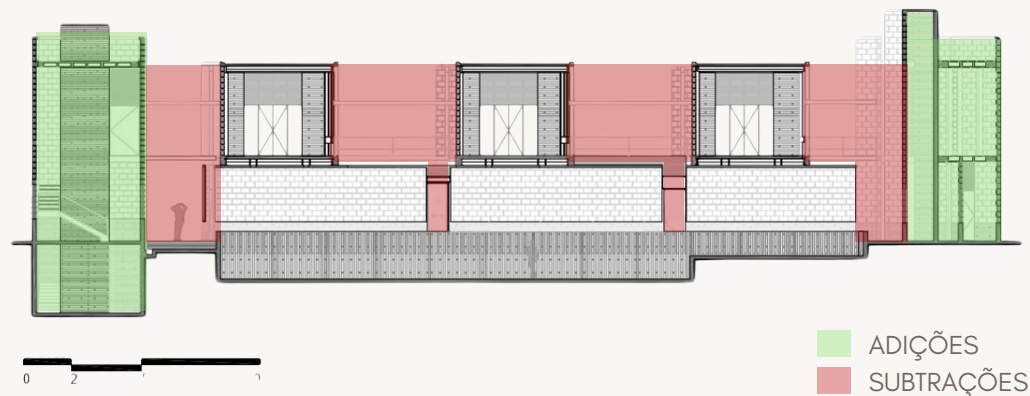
e 33: Cortes da edificação. ArchDaily, modificado (2024)
